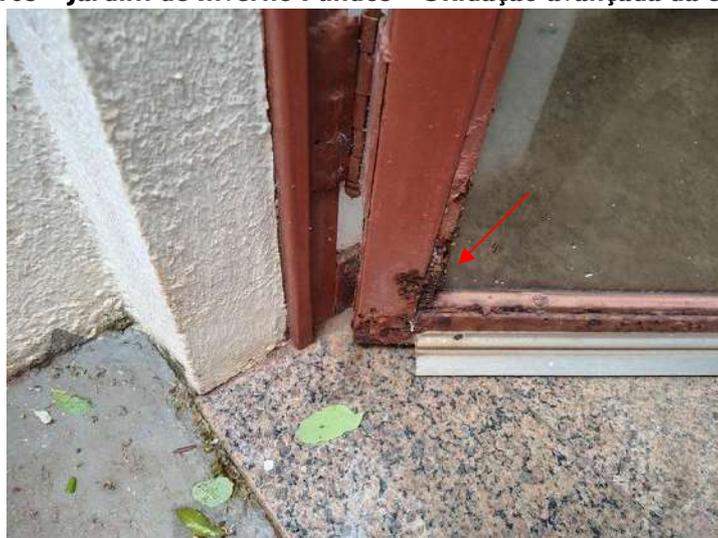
Jardim de Inverno Fundos – Oxidação avançada da porta de entrada
